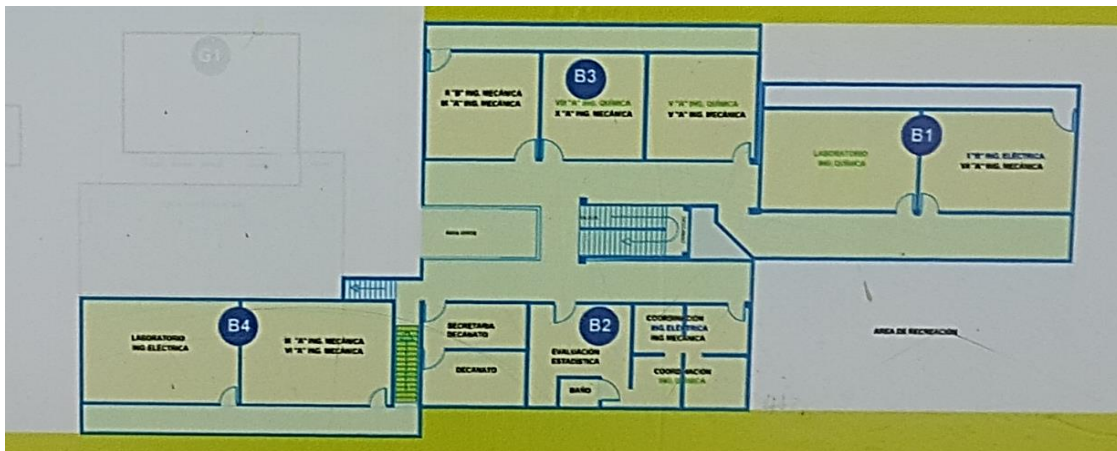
Croquis del laboratorio (Primera planta alta), UTELVT.
